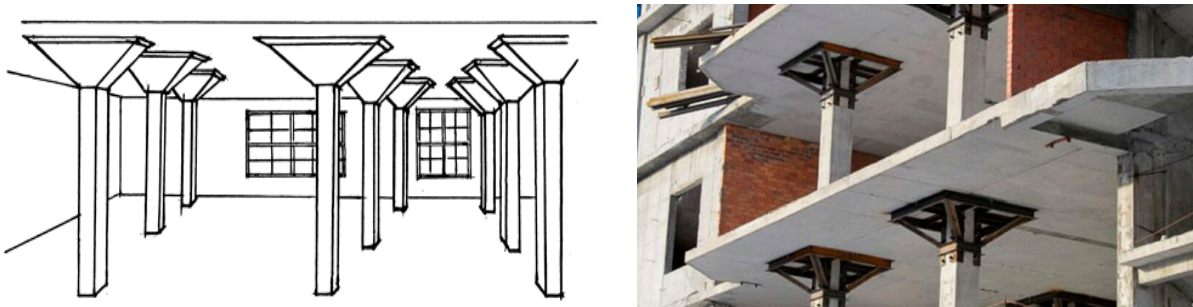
Безбалкове монолітне залізобетонне перекриття
